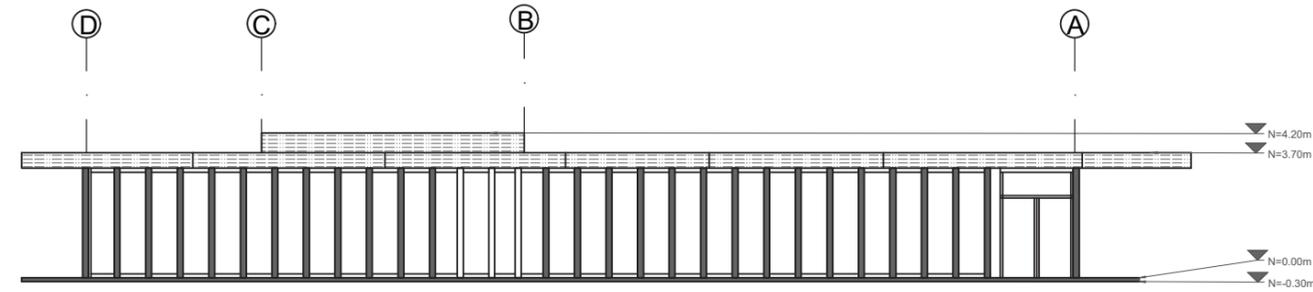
PLANIMETRÍA\_ELEVACIÓN LAT. DERECHA
